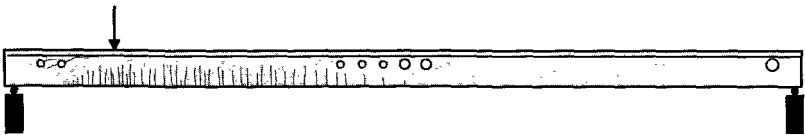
Rissbild Balken G15 nach dem Schubversuch
